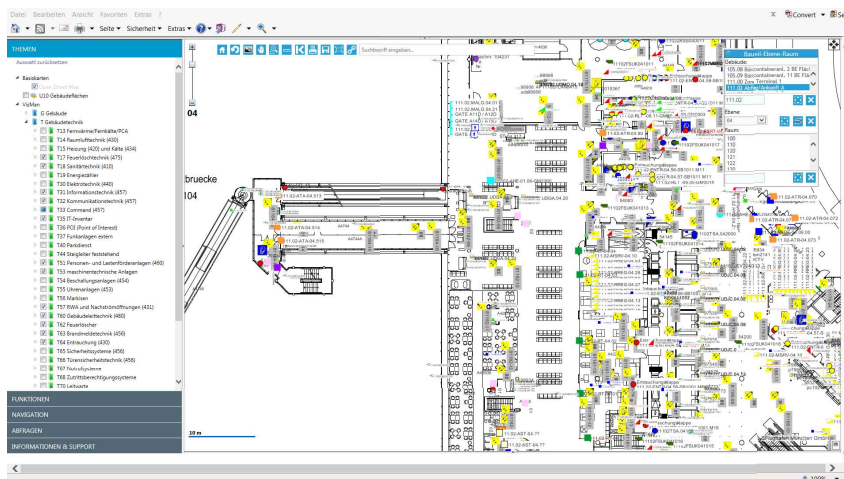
Web-System mit Visualisierung von SDO-Geometrie-Daten (hier der Grundriss eines Flughafen-Terminals mit Objekten aus dem Bereichen Sanitär-, Feuerlösch und Brandmeldetechnik).
